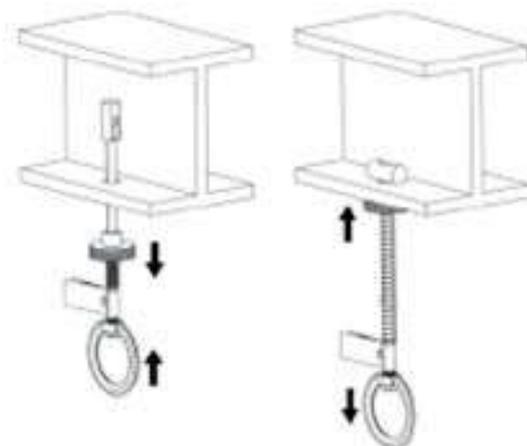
Dispositivo para taladros pasantes.
